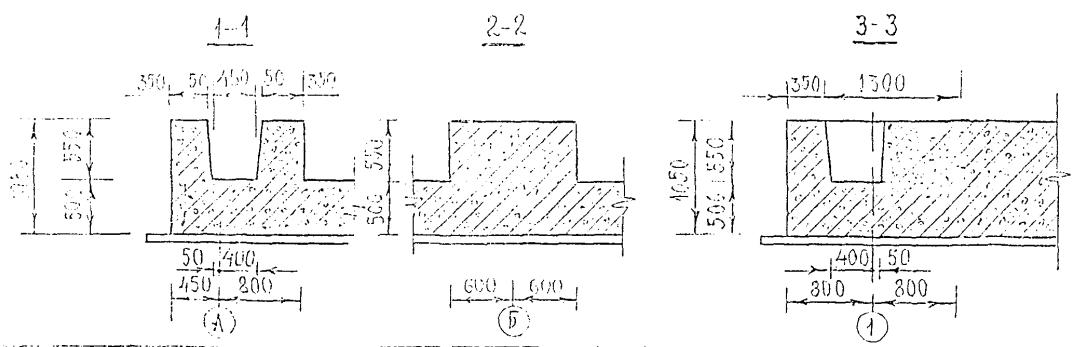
ФУНДАМЕНТНАЯ ПЛИТА.
